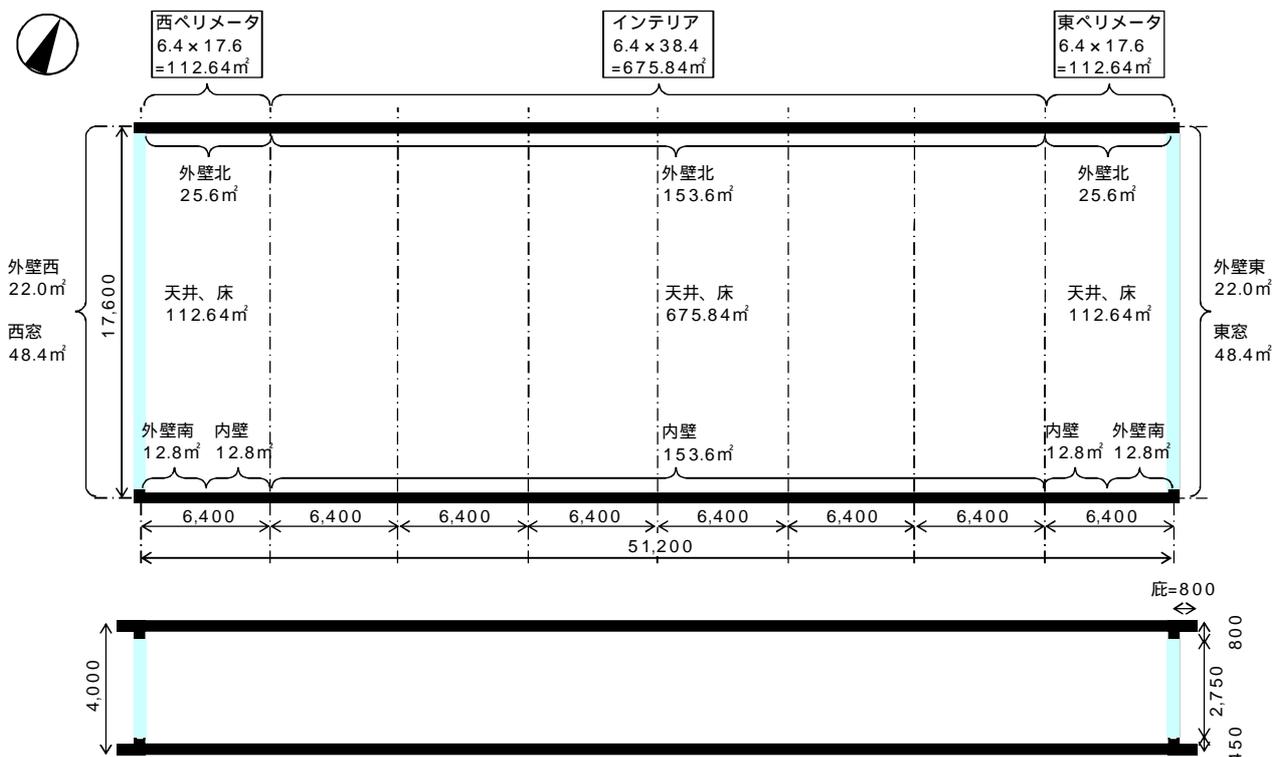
Aビルのモデル化した平面図（上）と断面図（下）
